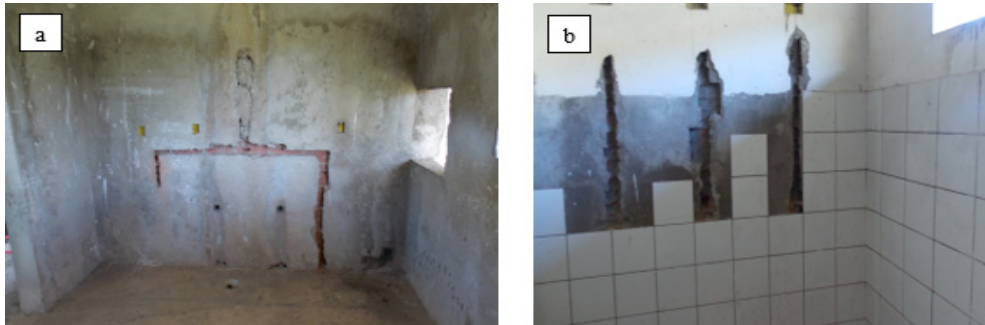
(a) Trinca na alvenaria devido ineficiência da contraverga. (b) Vista da instalação inadequada da barra de aço no furo do tijolo
